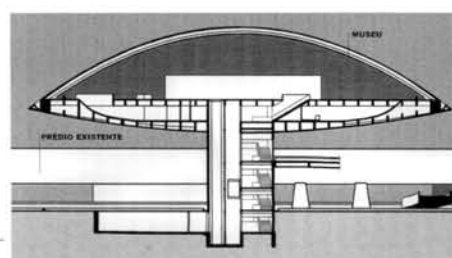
CORTE LONGITUDINAL DO "OLHO"
